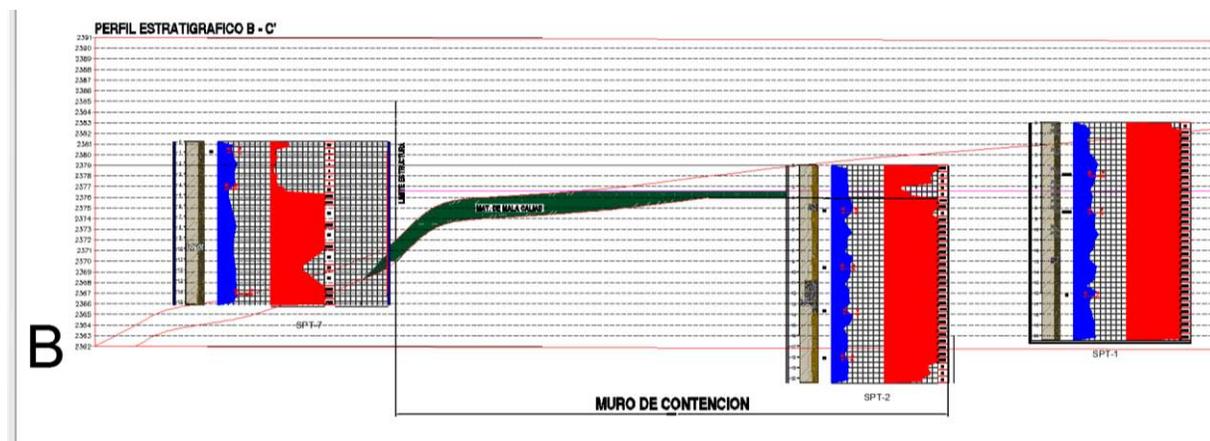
REQUERIMIENTO DE MUROS DE CONTENCION CORTE B - C`
